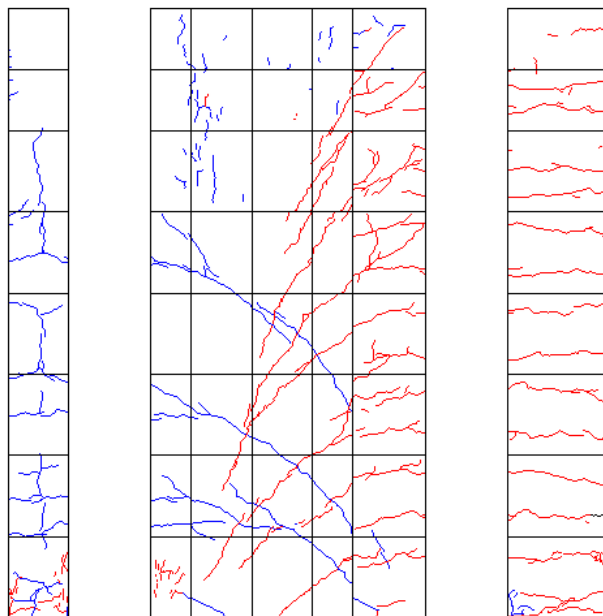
R=-1/67 ひび割れ図
